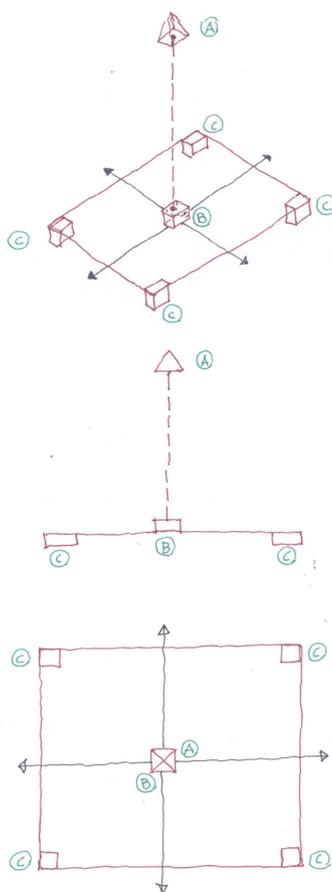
Piedra angular, Piedra fundamental y Piedra de fundación.
